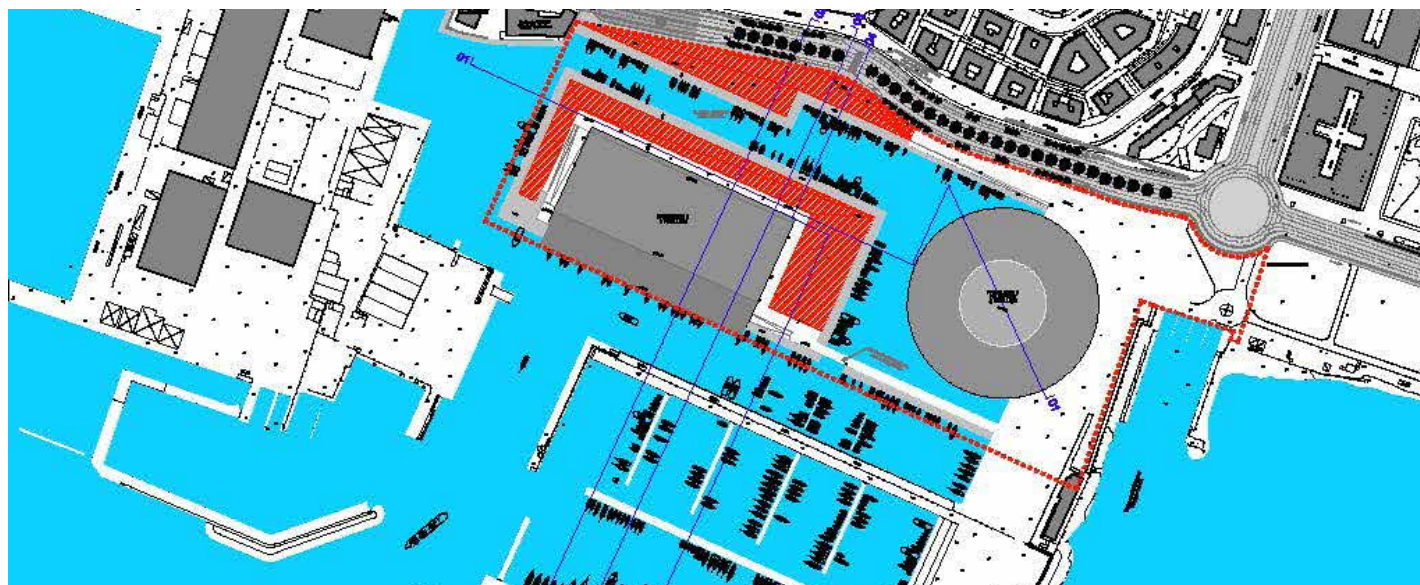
Planimetria generale dello stato di progetto del concorso "Blueprint Competition"
